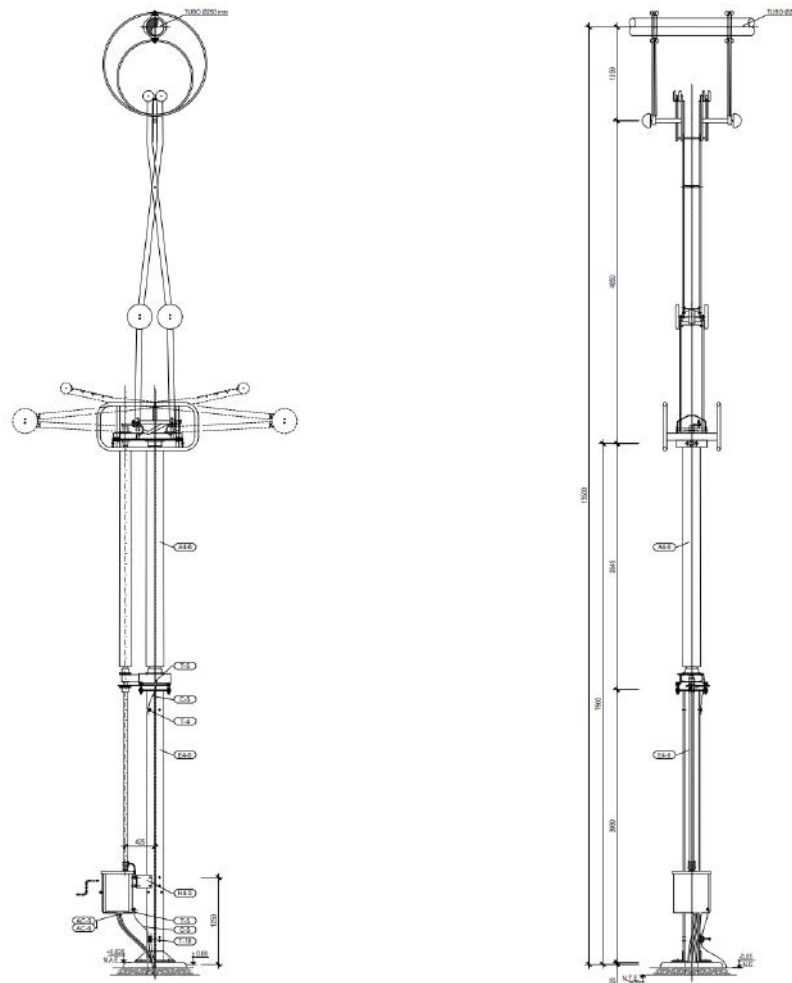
Alzado principal y lateral del seccionador pantógrafo tripolar
